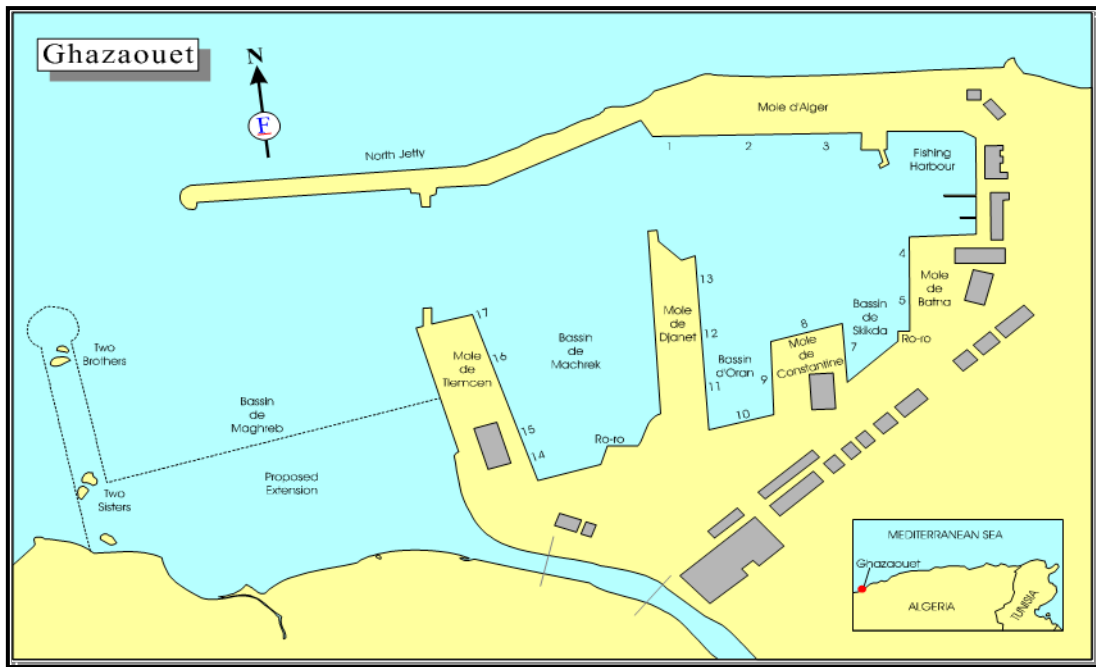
Plan du port de Ghazaouet (M.T.O.N.M, 2013)
